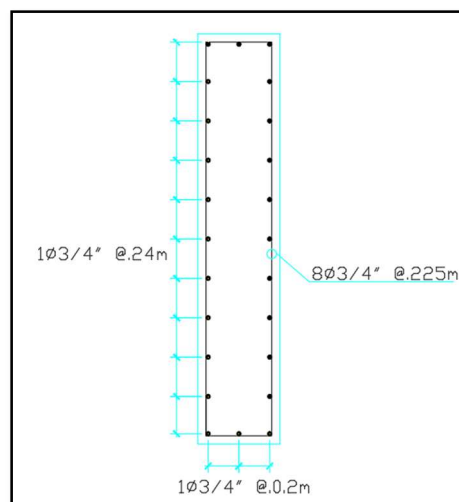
Distribución acero refuerzo viga 2.50 m x 0.50 m.
